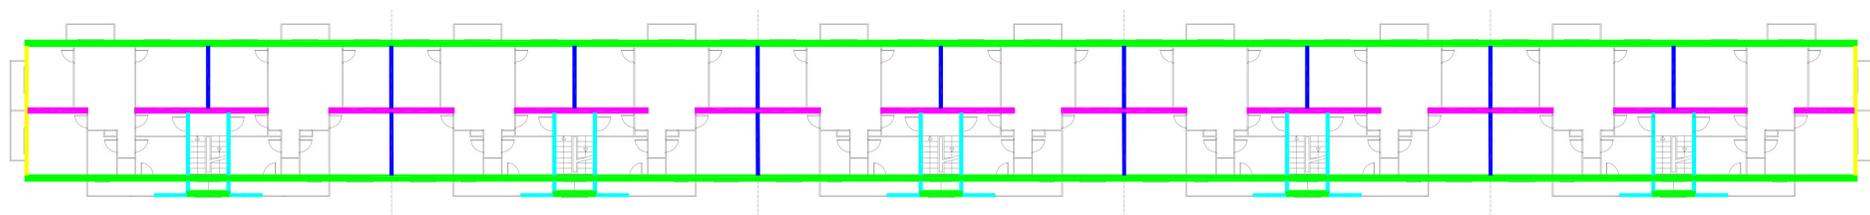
Tipologías de fachada. Fuente: Elaboración propia.
